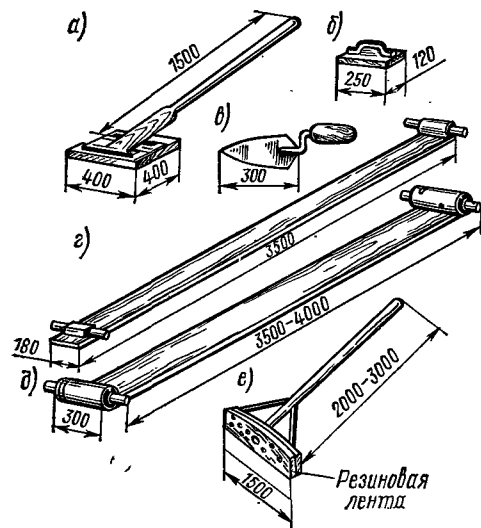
Инструменты для заглаживания и отделки бетонных поверхностей: а — гладилка; б — полутерок; в — кельма; г — доска для заглаживания; д — лента; е — скребок
